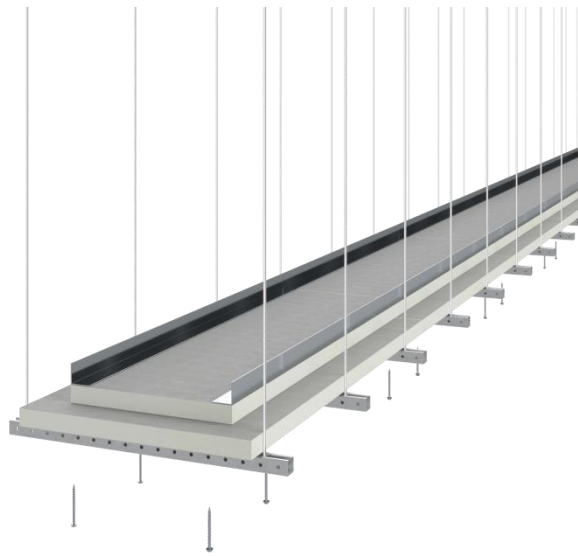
Установка монтажного уголка DG3030 или DG6060 при помощи саморезов
